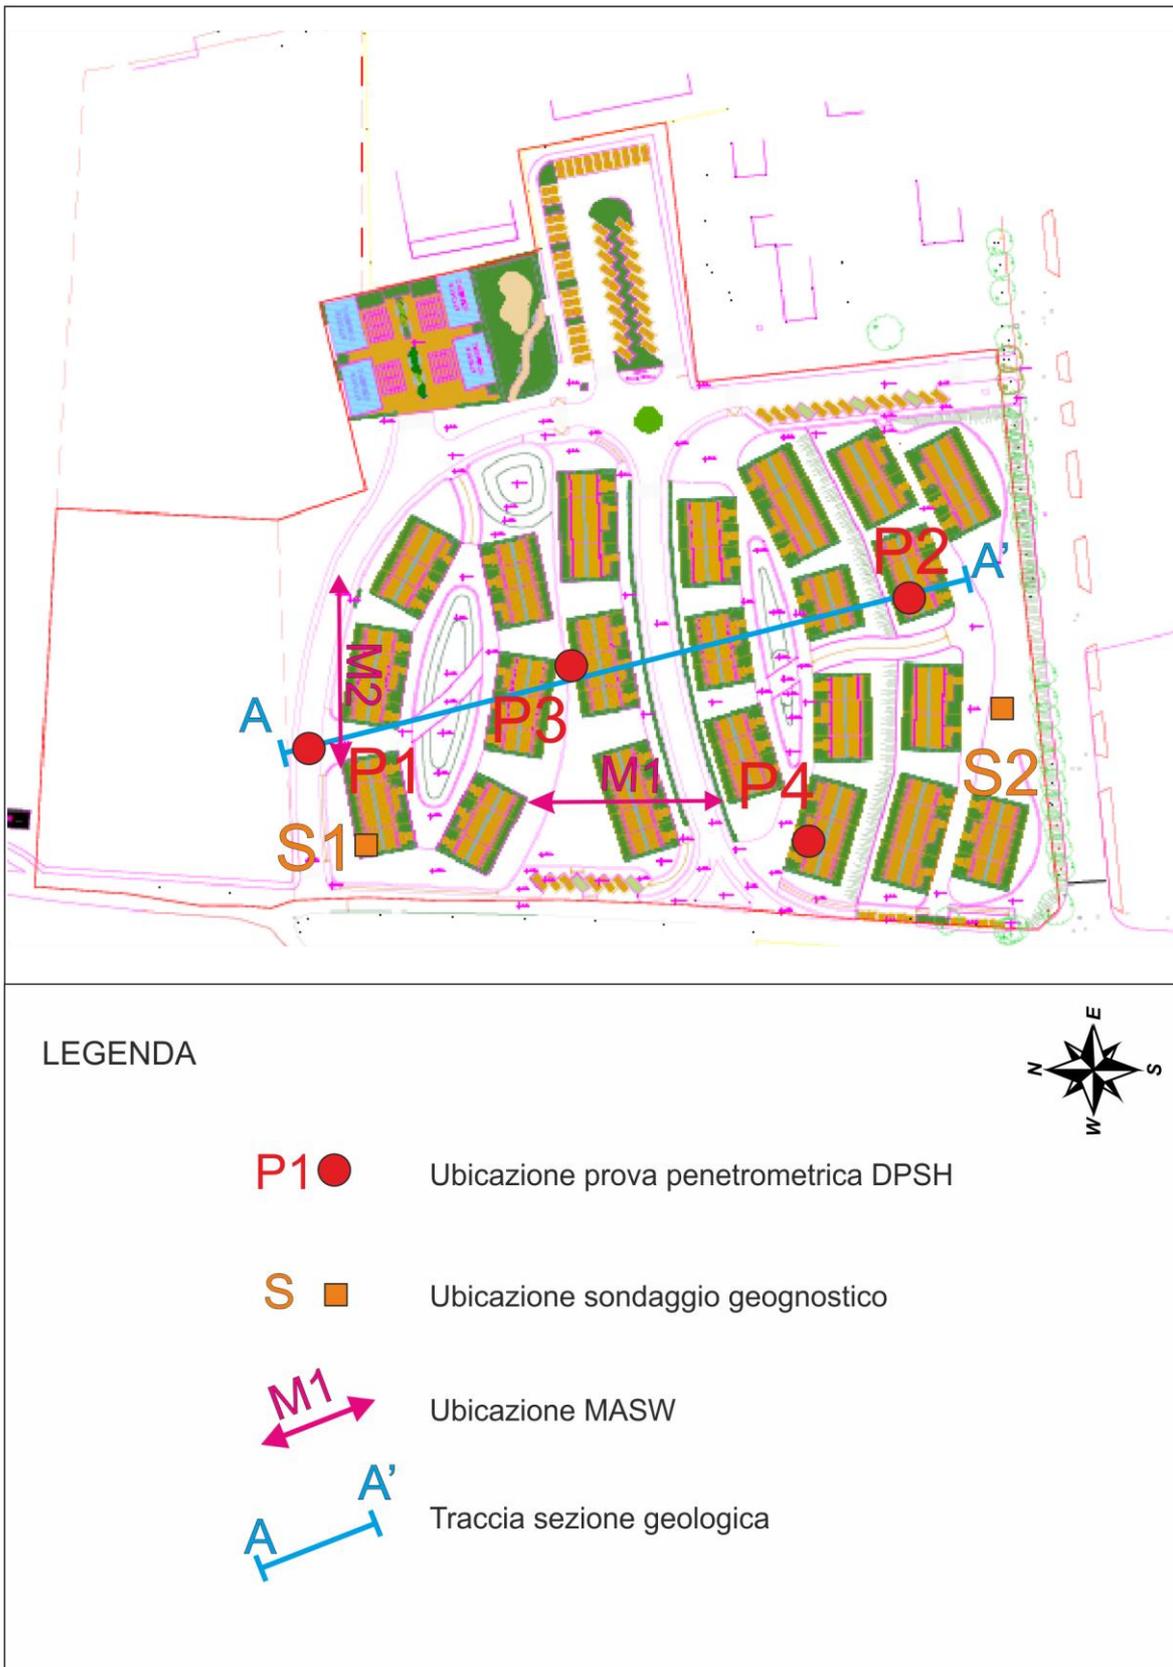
Pianta progetto con ubicazione indagini – scala 1:2.000
